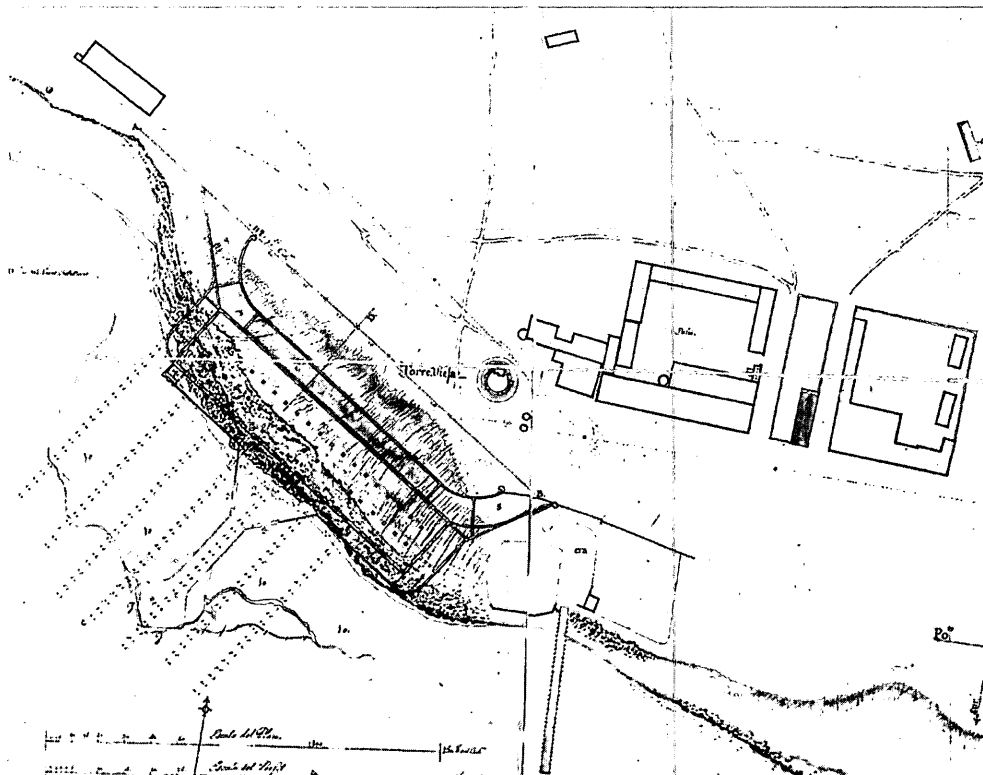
Detalle del plano de proyecto de construcción de la Era de la sal y muelle de poniente (1777).
